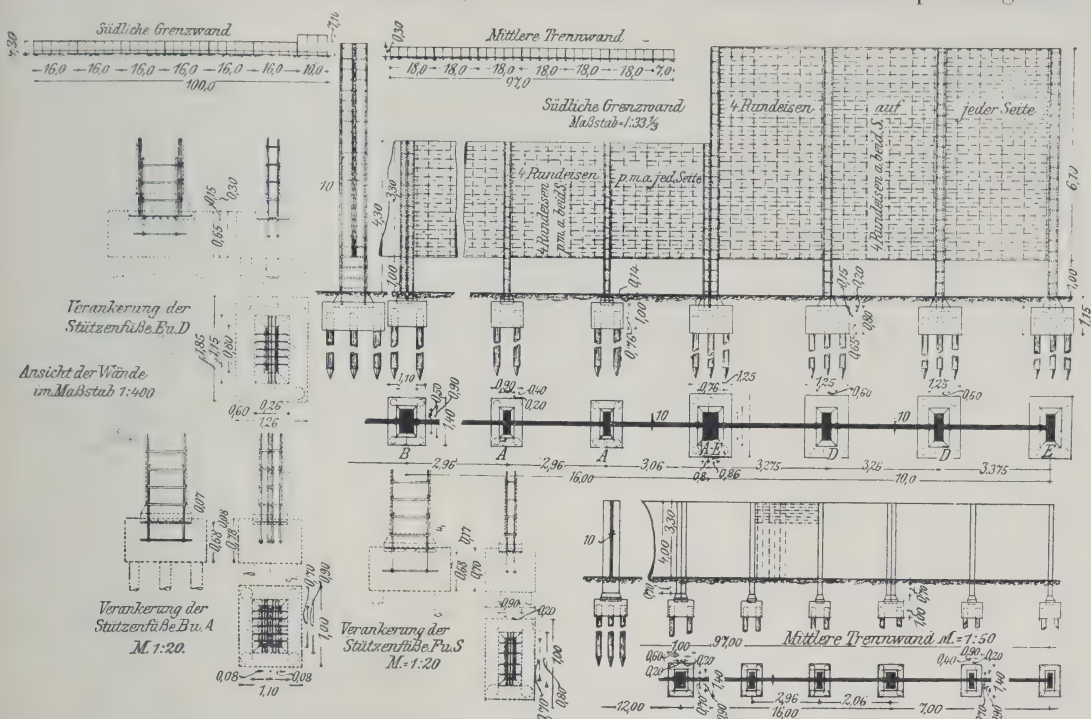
Grundrisse und Schnitte des Schießstandes in Bremen.
